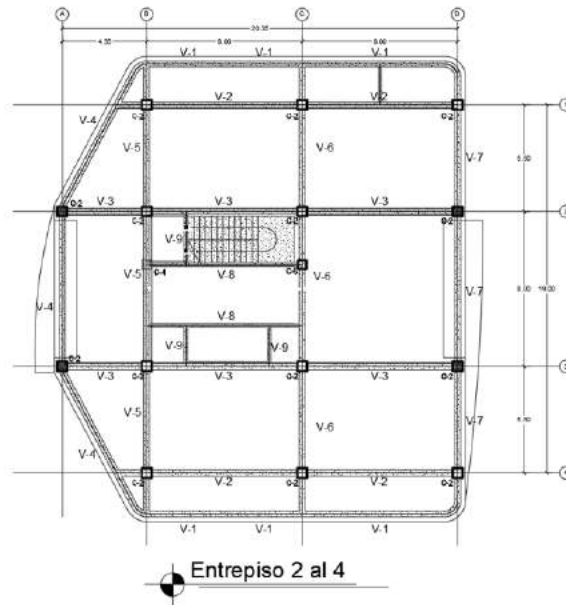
Planta de Modelo 2, entrepiso 2 al 4
